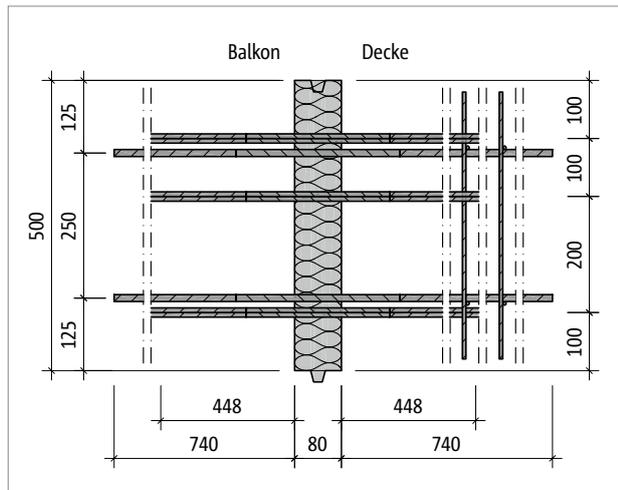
Schöck Isokorb® T Typ DP-MM1-VV3: Grundriss
